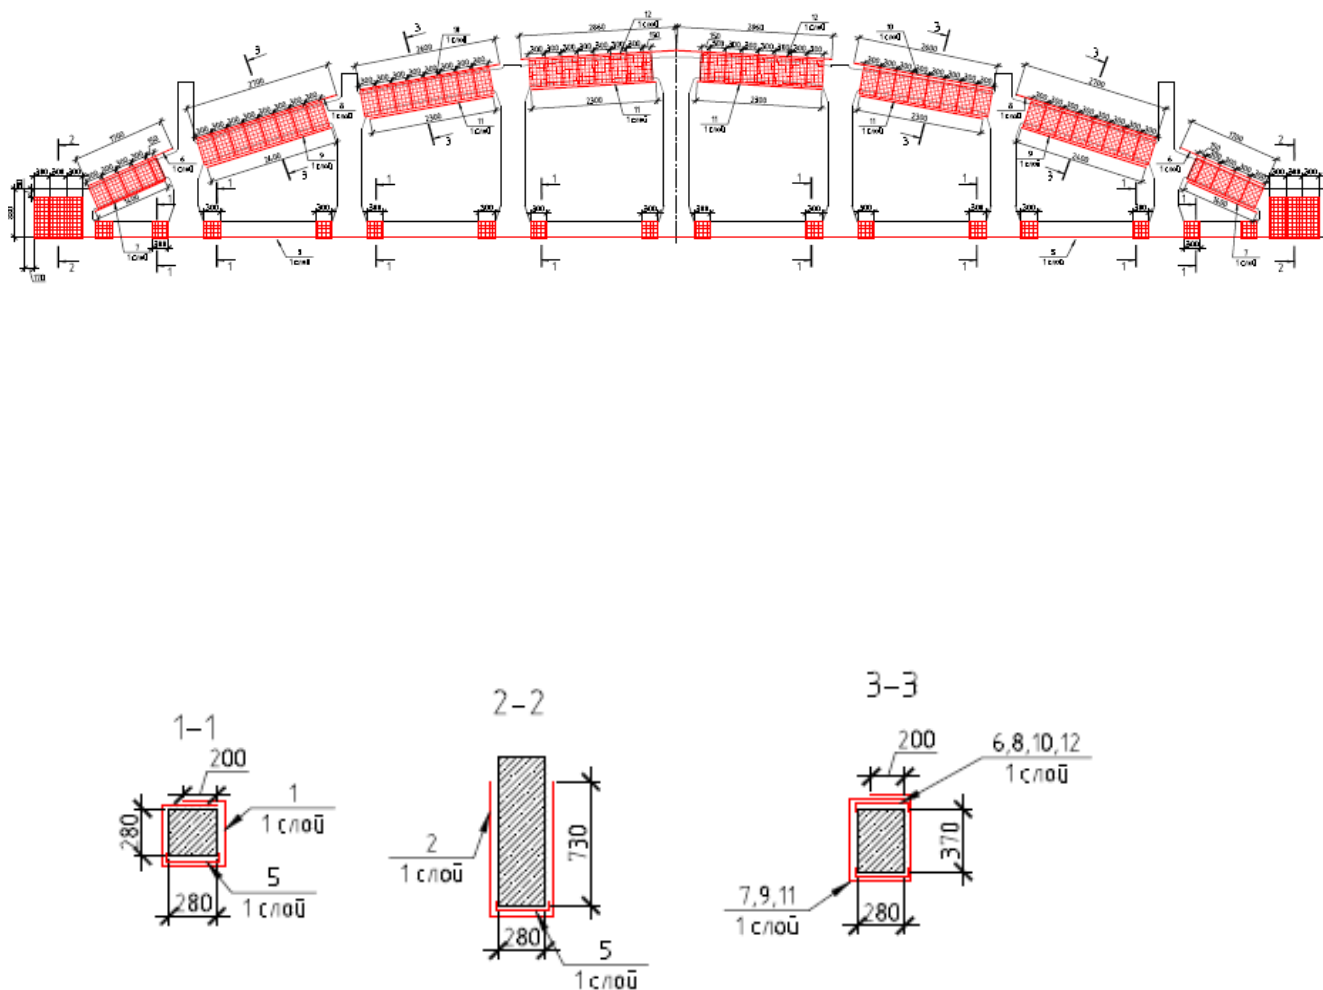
Усиление железобетонной фермы по серии 1.463-3/87 углеродными лентами CarbonWrap® Tape (сечения элементов)
